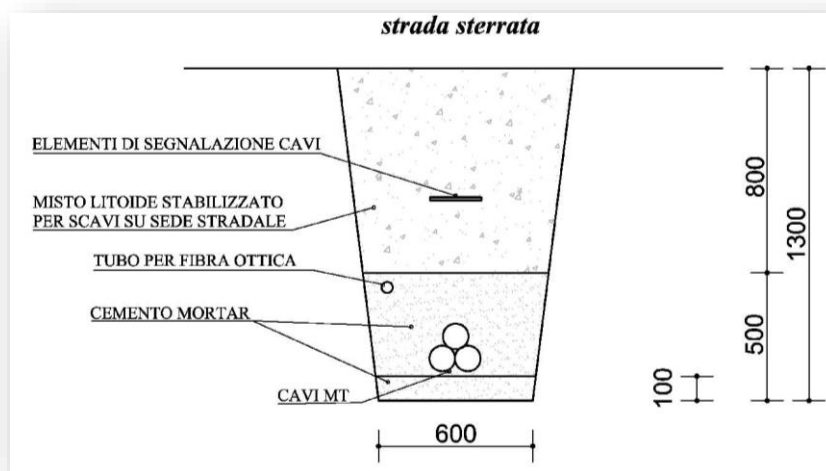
Sezione tipica di posa su sede stradale sterrata
